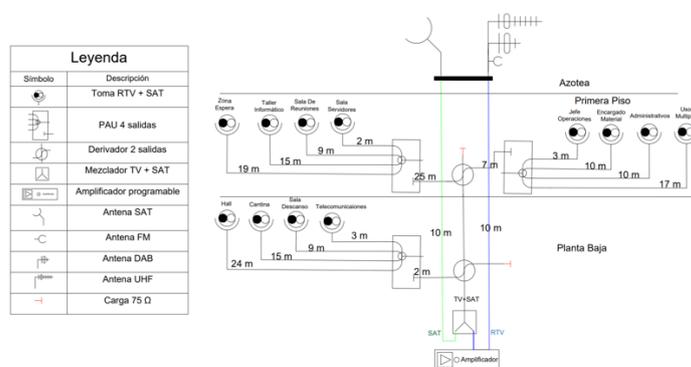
ANEXO H. Esquema instalación ICT en Planta Baja y Planta Piso
